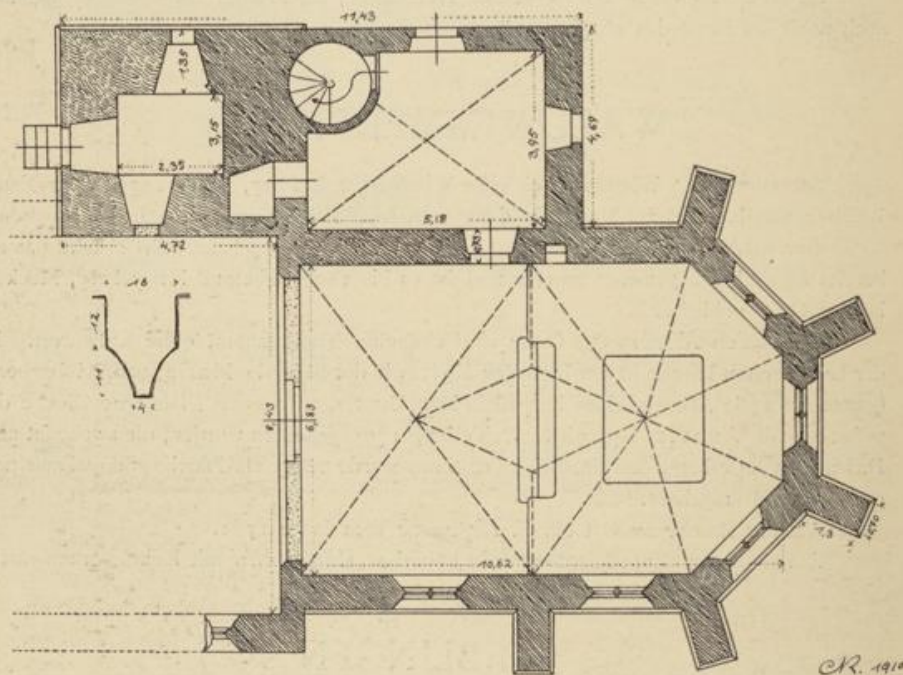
Grundriß der ehemaligen Kirche in Wieblingen.
